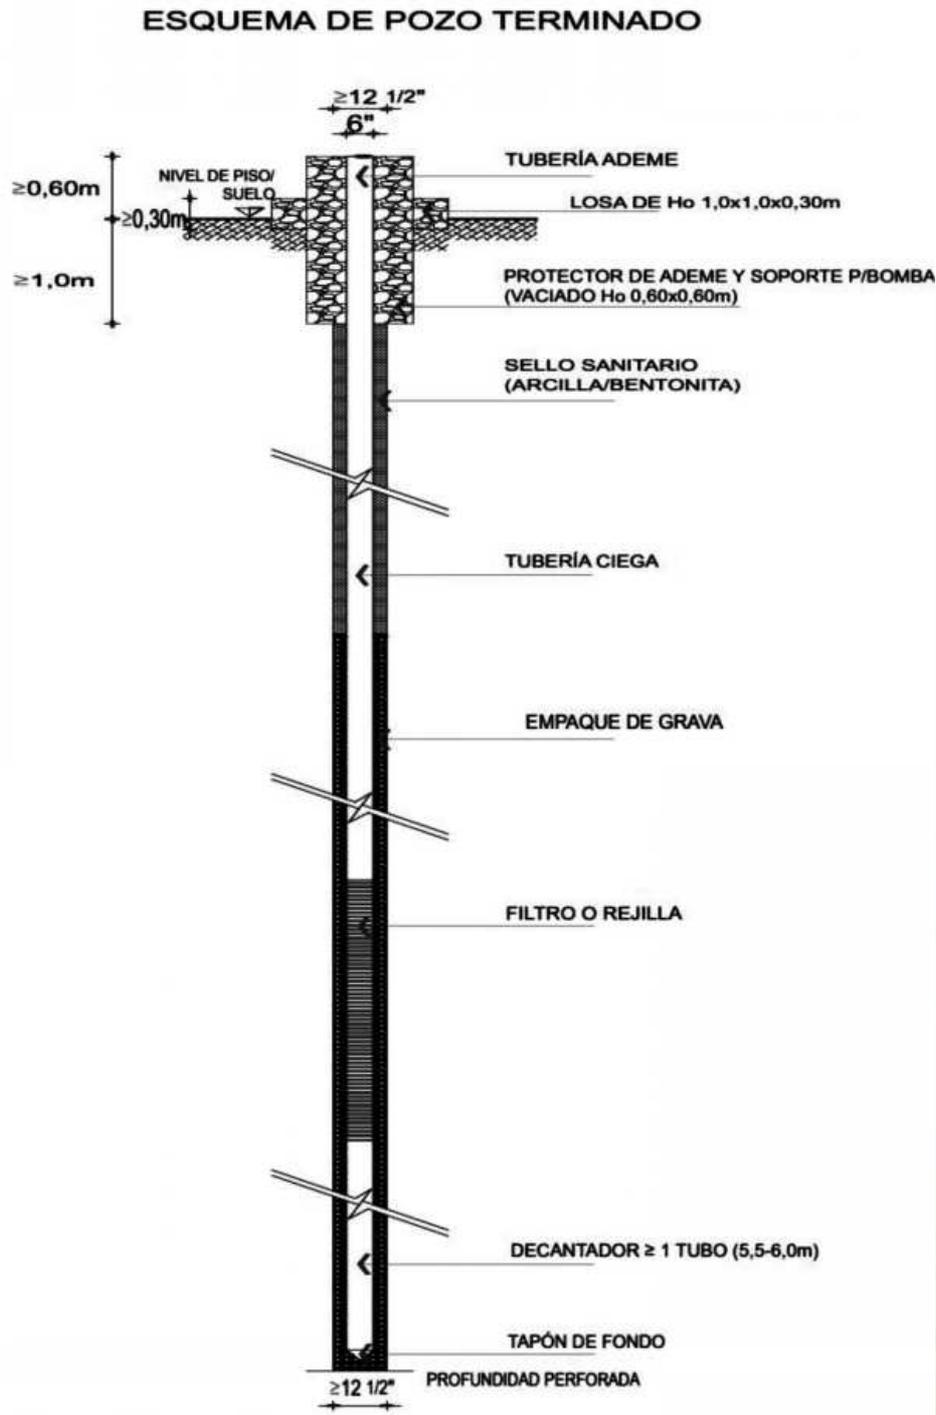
Protector de tubería de ademe y Base soporte de bomba
